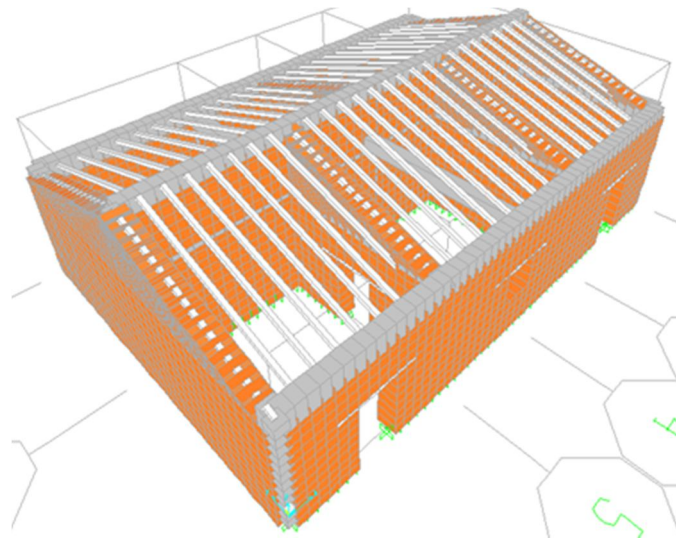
Modelo da estrutura com a introdução de uma viga de bordadura em betão armado
